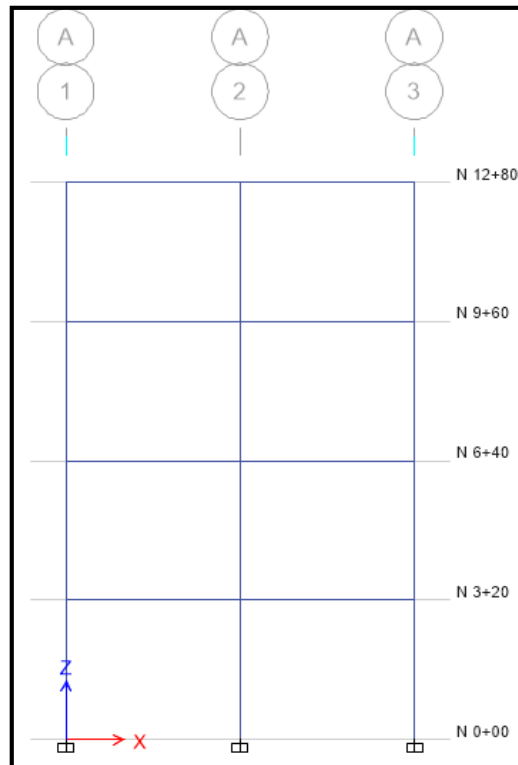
Elevación vista en el plano X-Z con Pórticos resistentes a momento.
